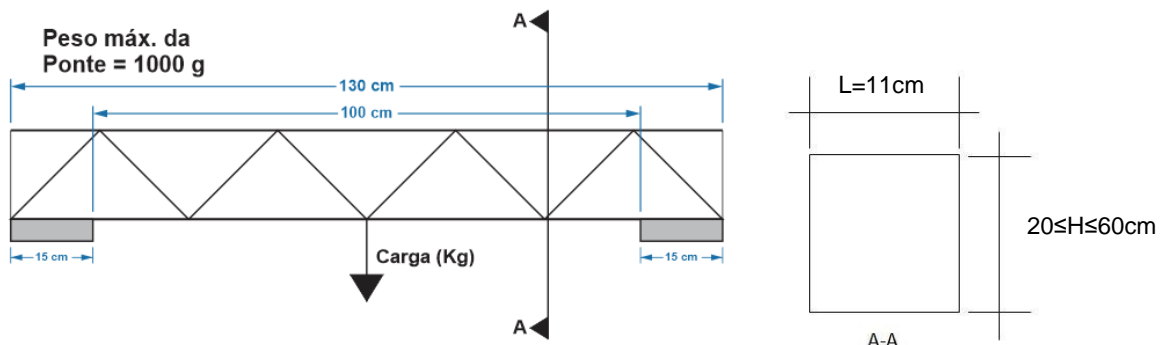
Dimensões da ponte e ponto de aplicação de carga
